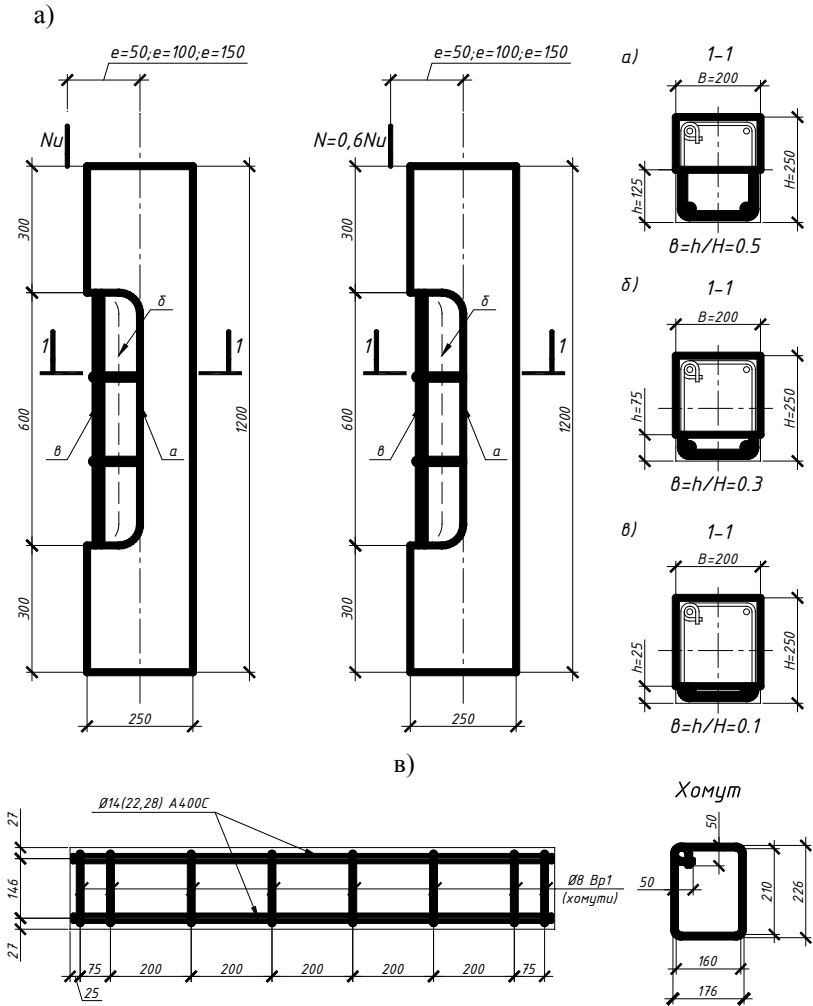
Конструкція дослідних зразків: а) вид та рівень навантаження (а,б,в-поперечні перерізи з коефіцієнтом пошкодження ν); в) схема армування
